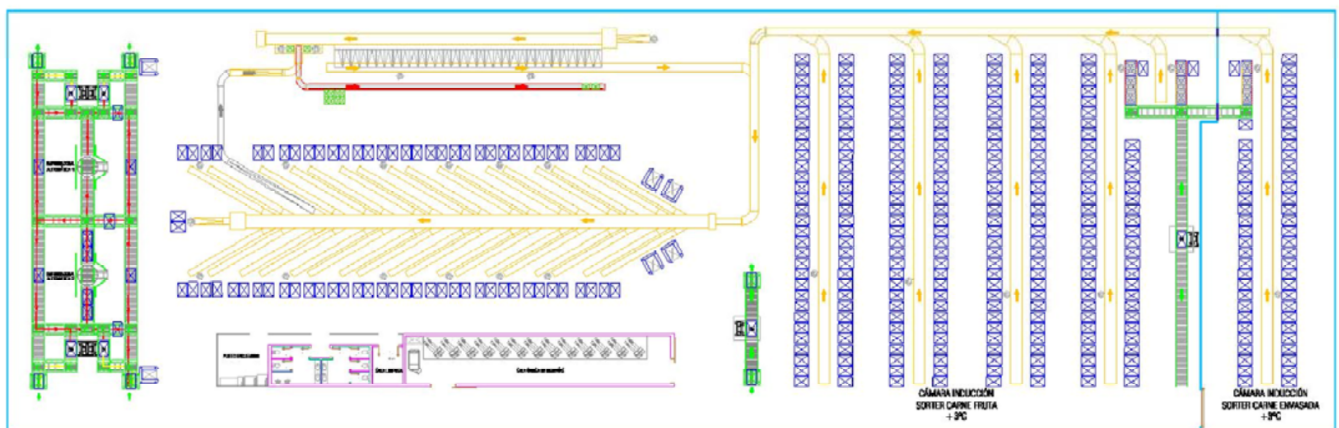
Detalle planta altillo escenario semiautomático Fuente Elaboración propia
